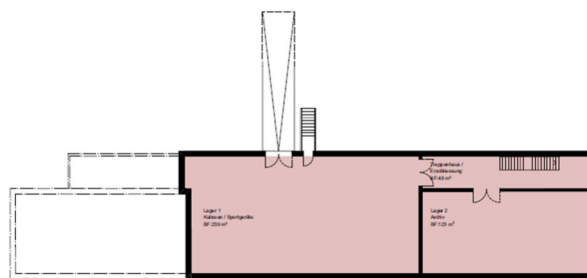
Disposition 1.2 | Grundriss Untergeschoss
